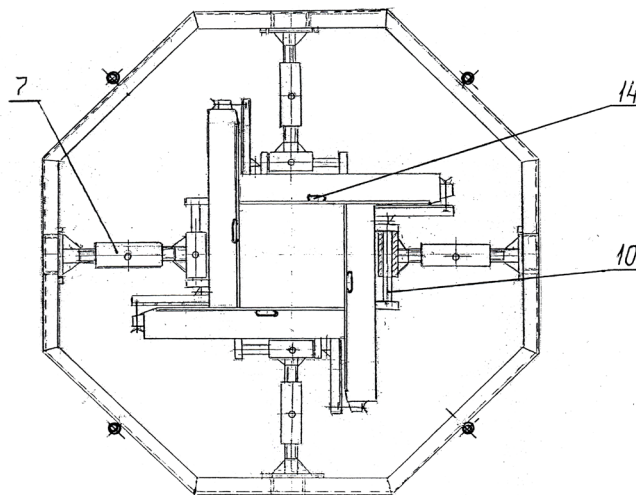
Вид опалубки в плане, для возведения колонн сечением 40x40 см
